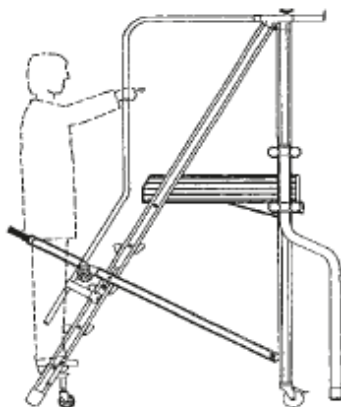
non dare mai le spalle alla scala. Sostare sulla piattaforma solo se è presente un parapetto adeguato
